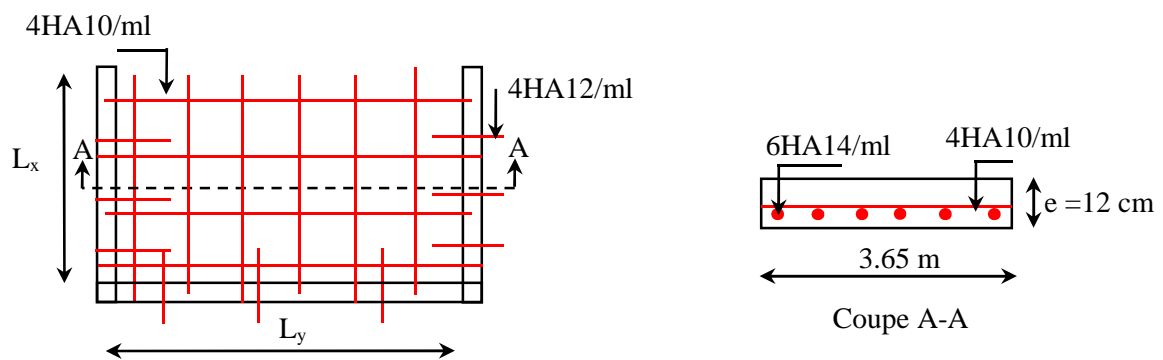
Schéma de ferrailage de la dalle D3'.
